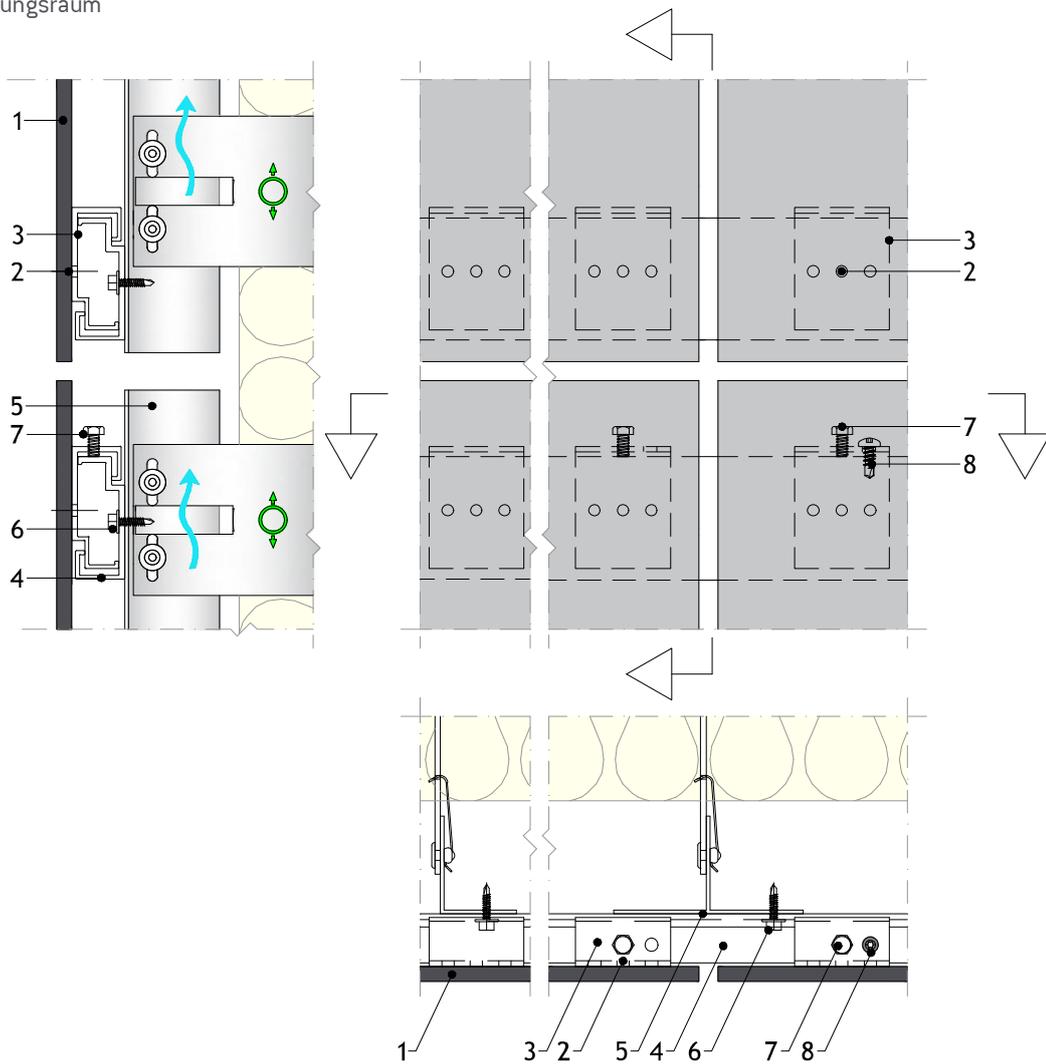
Fest- und Gleitpunktssystem der Unterkonstruktion
